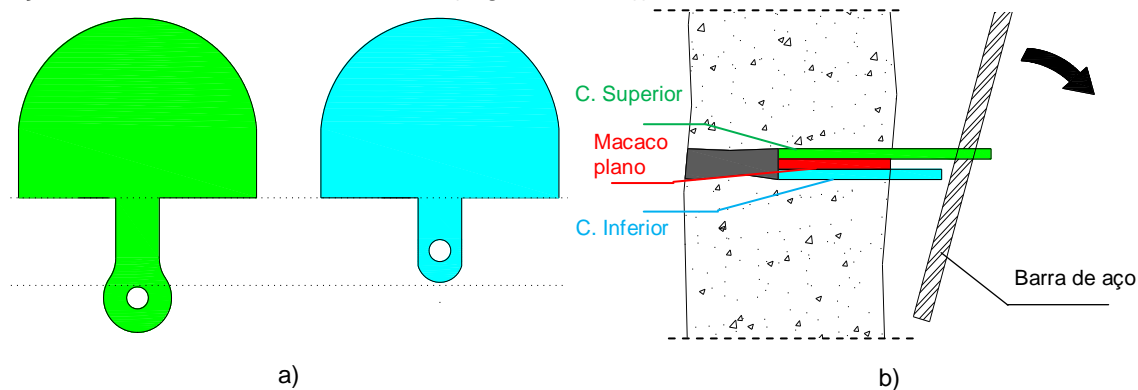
Chapas de protecção dos macacos: a) geometria (vista em planta); b) esquema de colocação e modo de remoção (corte do plano vertical da parede).
